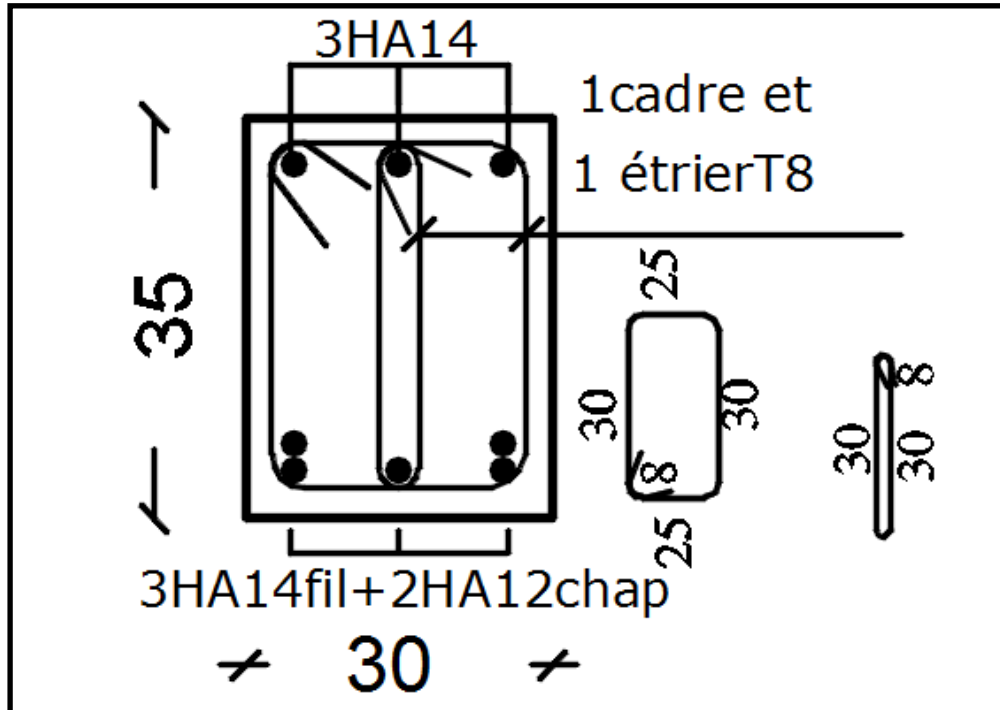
Ferraillage en travée d'une poutre secondaire.
